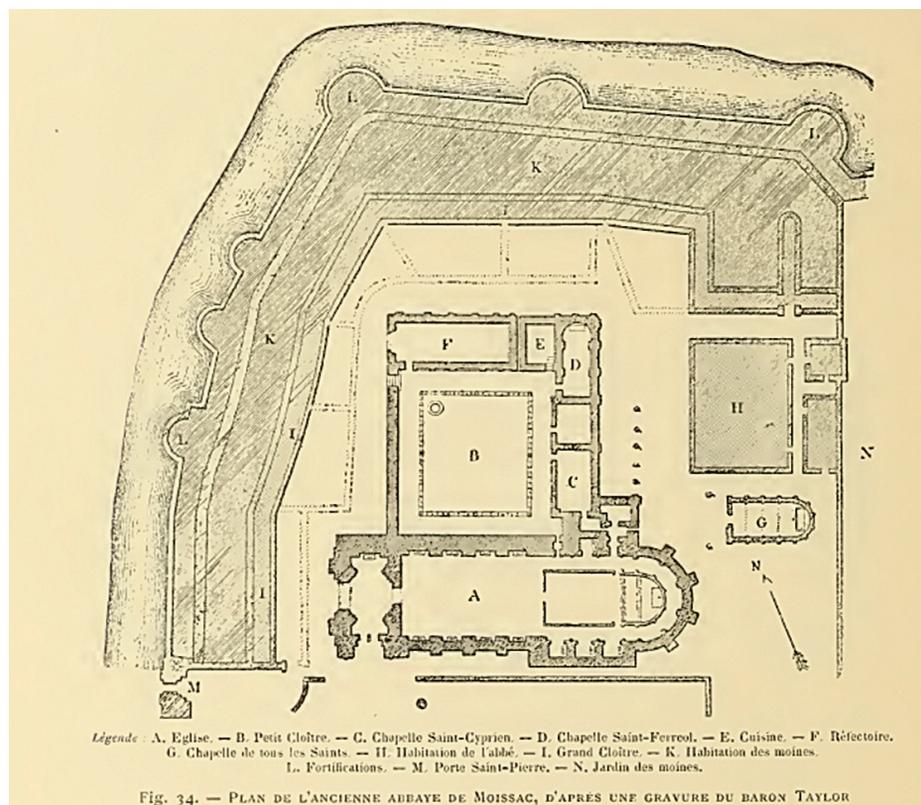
Plan de l'abbaye de Moissac (1820-1863)
